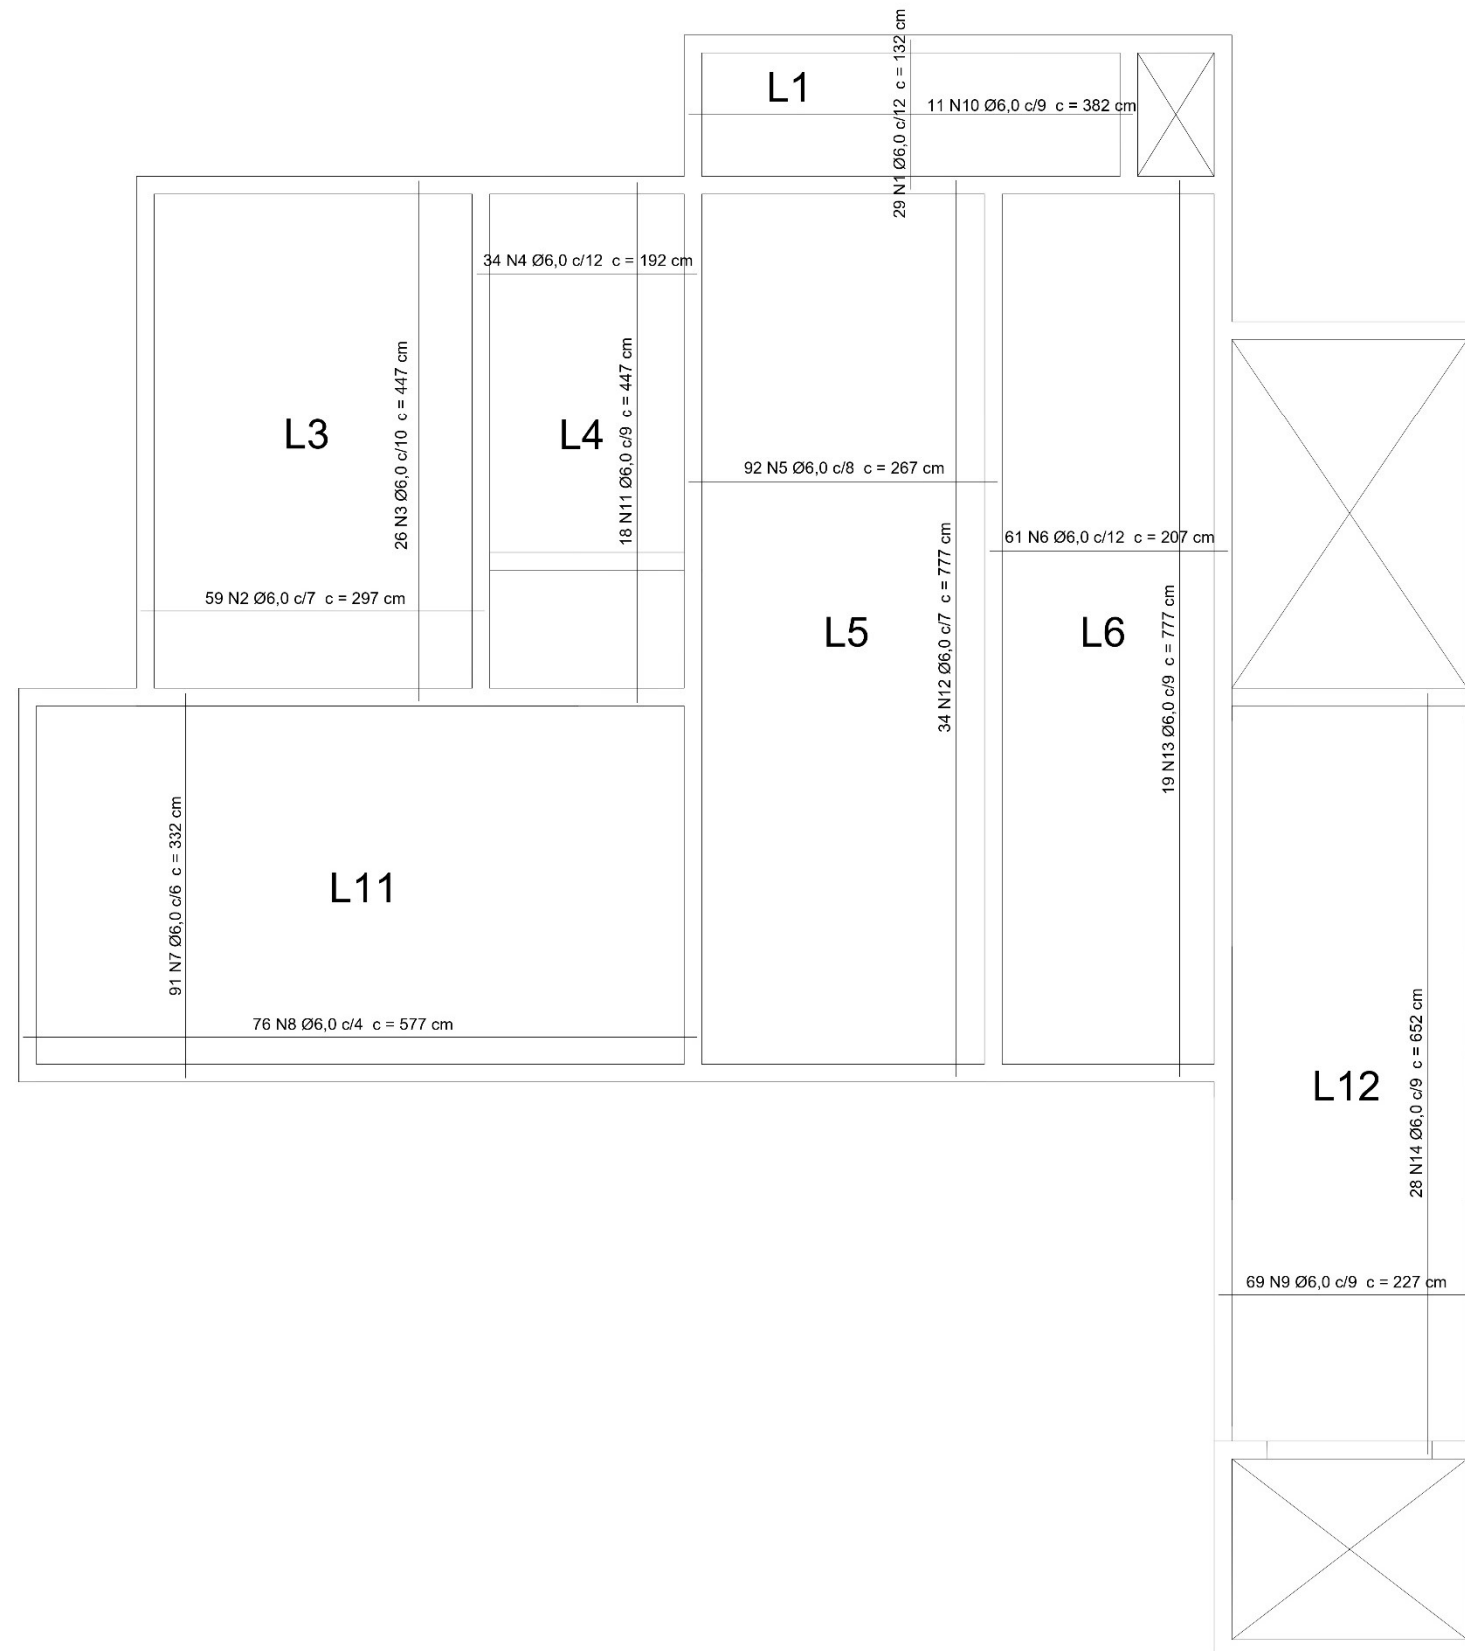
Planta de armadura de flexão positiva e retração e temperatura das lajes armadas com BFRP
